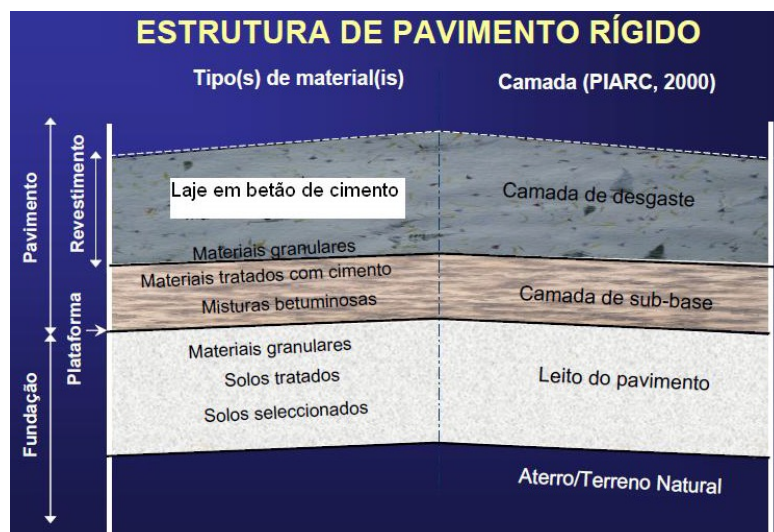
Estrutura de um pavimento rígido (Antunes *et al.*, 2005)
